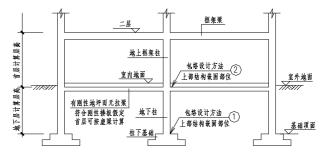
首层地面设置钢筋混凝土刚性地坪板而无拉梁
